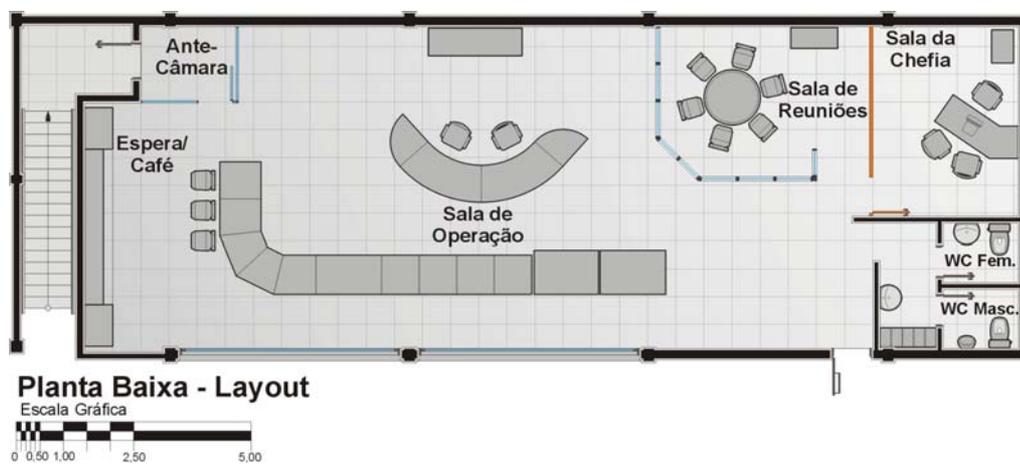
Planta do leiaute proposto pela GastalPons Ltda
